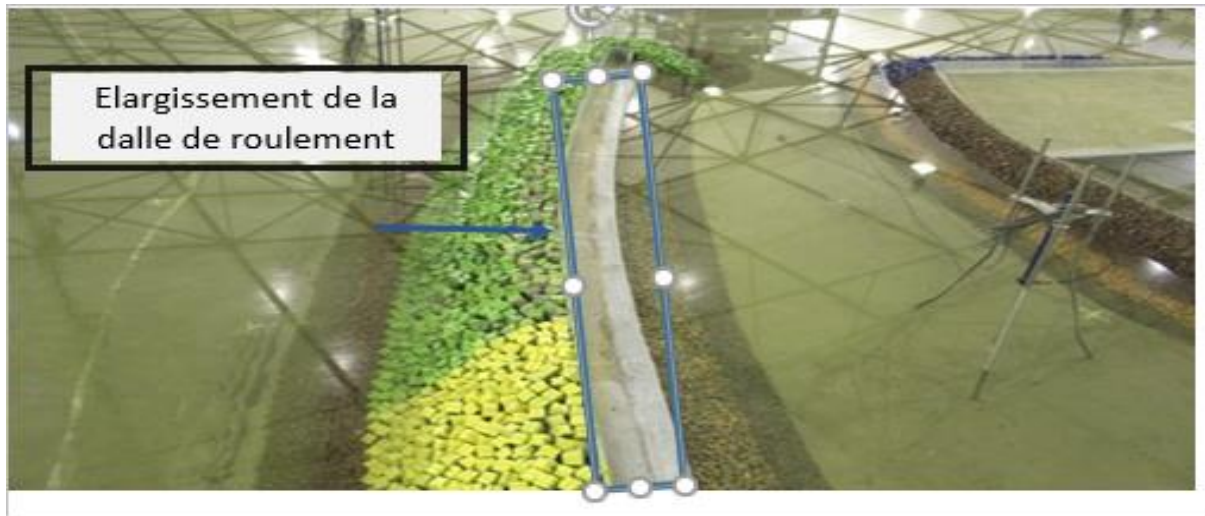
Élargissement de la dalle de roulement de la jetée principale pour atteindre 12,10m.
